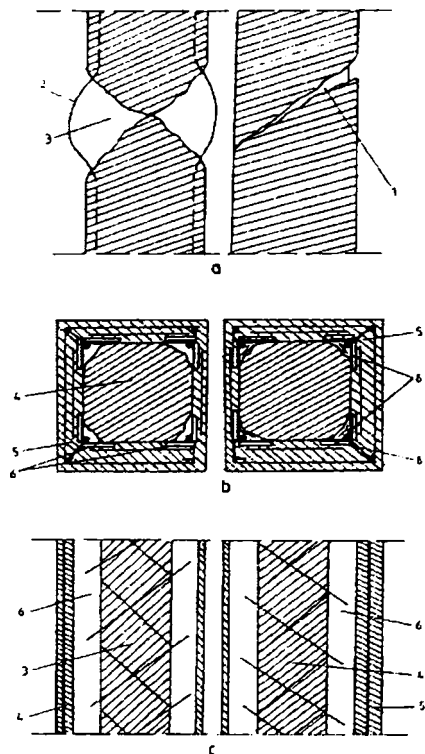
Consolidare zona degradata cu platbande metalice; a- defecte intinse la stlpul de rost; b- consolidare - sectiune transversala; c- consolidare sectiune longitudinala. 1 - stilp de rost; 2 - fisura; 3 - ruperea betonului si exfolierea armaturii; 4 - beton consistent; 5 - camasiua; 6 - platbande din metal.
